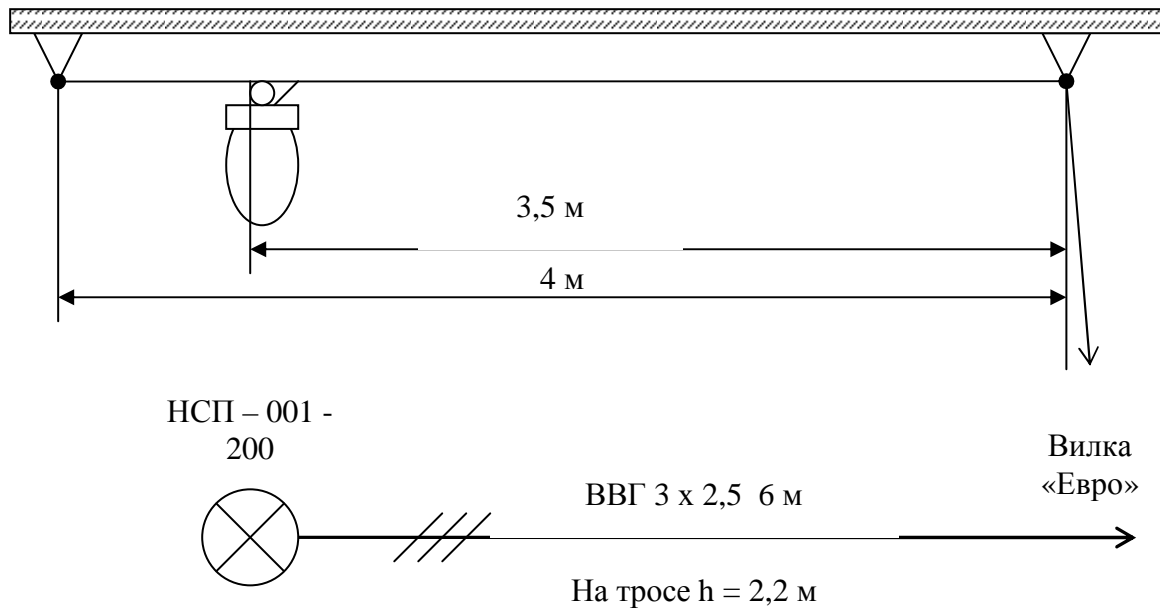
Монтажная и принципиальная схема тросовой проводки
